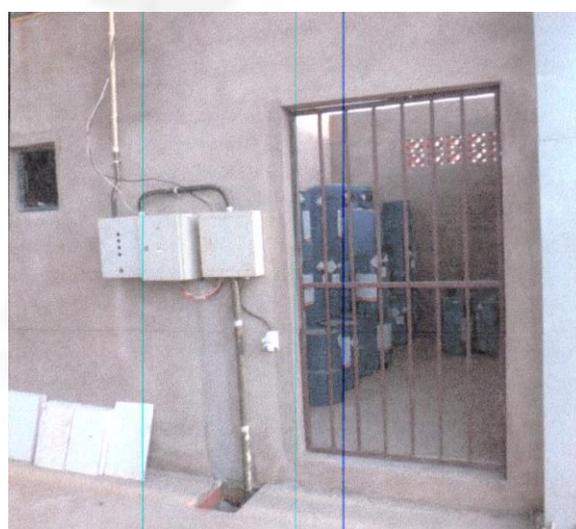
Depósito de produtos tóxicos em fase final de construção.
